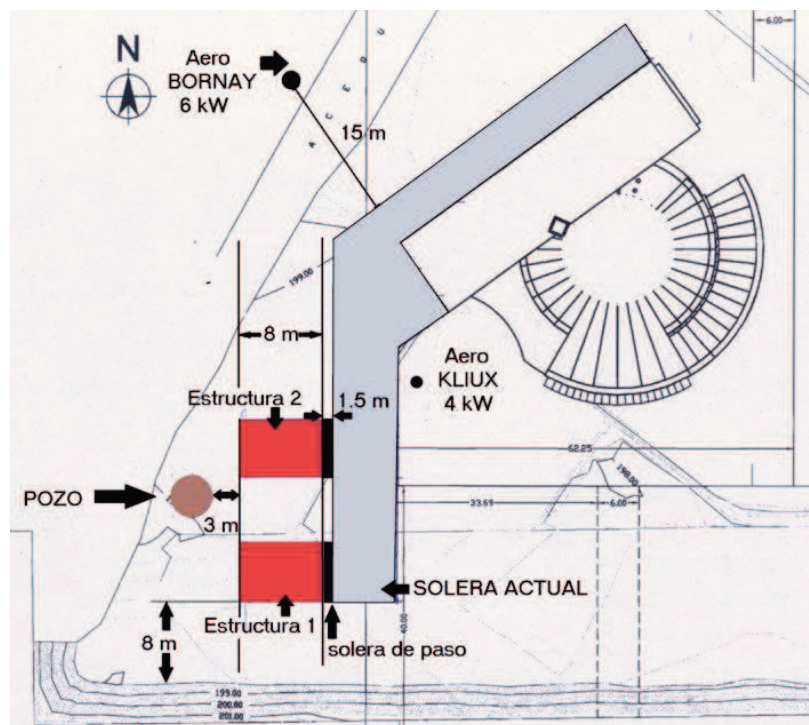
Esquema de ubicación de la cimentación para las estructuras.
